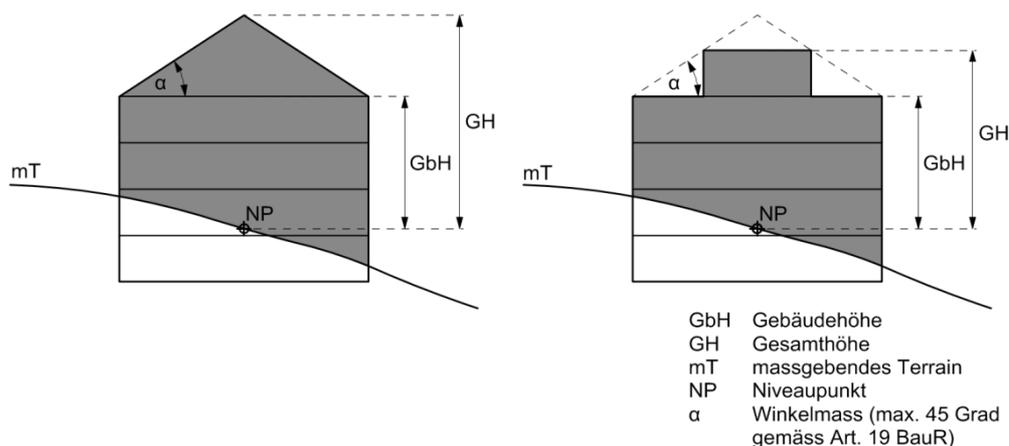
Schnittpunkt „Fassadenoberkante“
